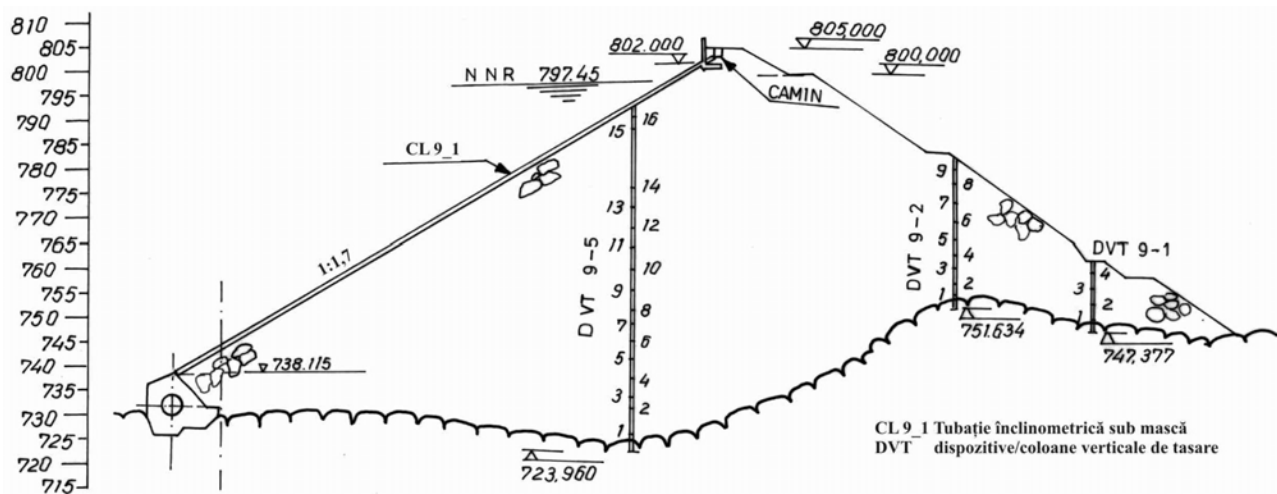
Profil transversal 9 – 9 de echipare cu aparatură de măsură a deformațiilor. Baraj Colibița
